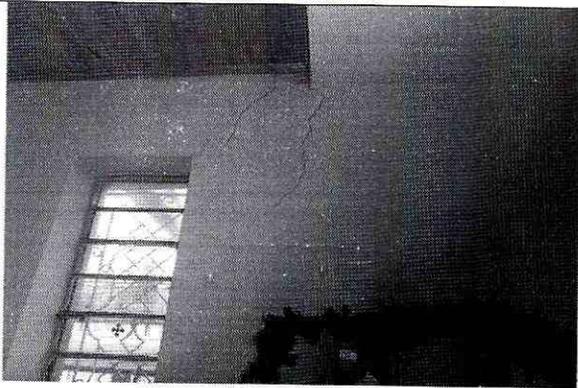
Agrietamientos en muros del primer piso, costado sur occidental.
